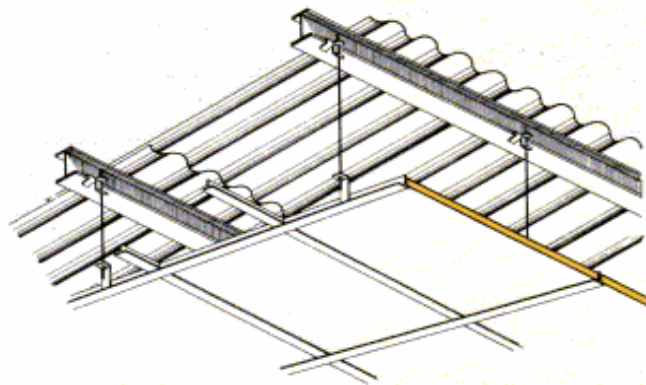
Estrutura metálica para colocação de tecto falso com painéis em lâ de vidro.
